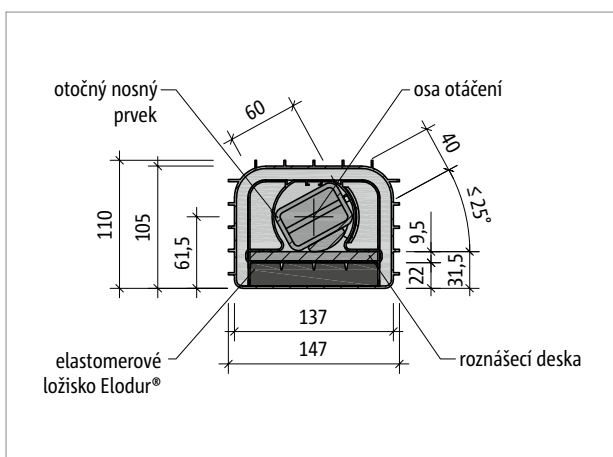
Schöck Tronsole® typ Q: Půdorys prvku
